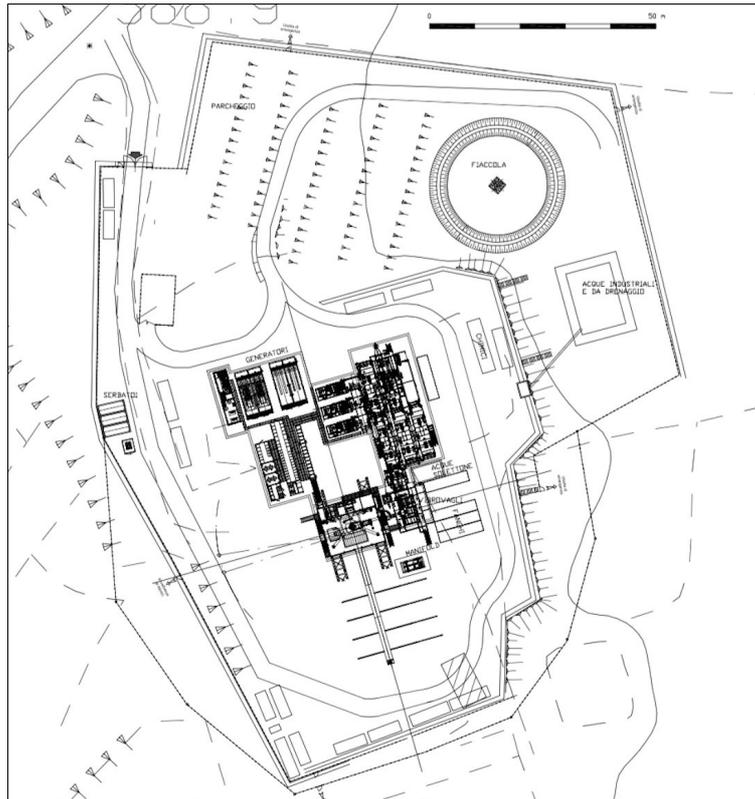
Planimetria dell'impianto temporaneo di perforazione
